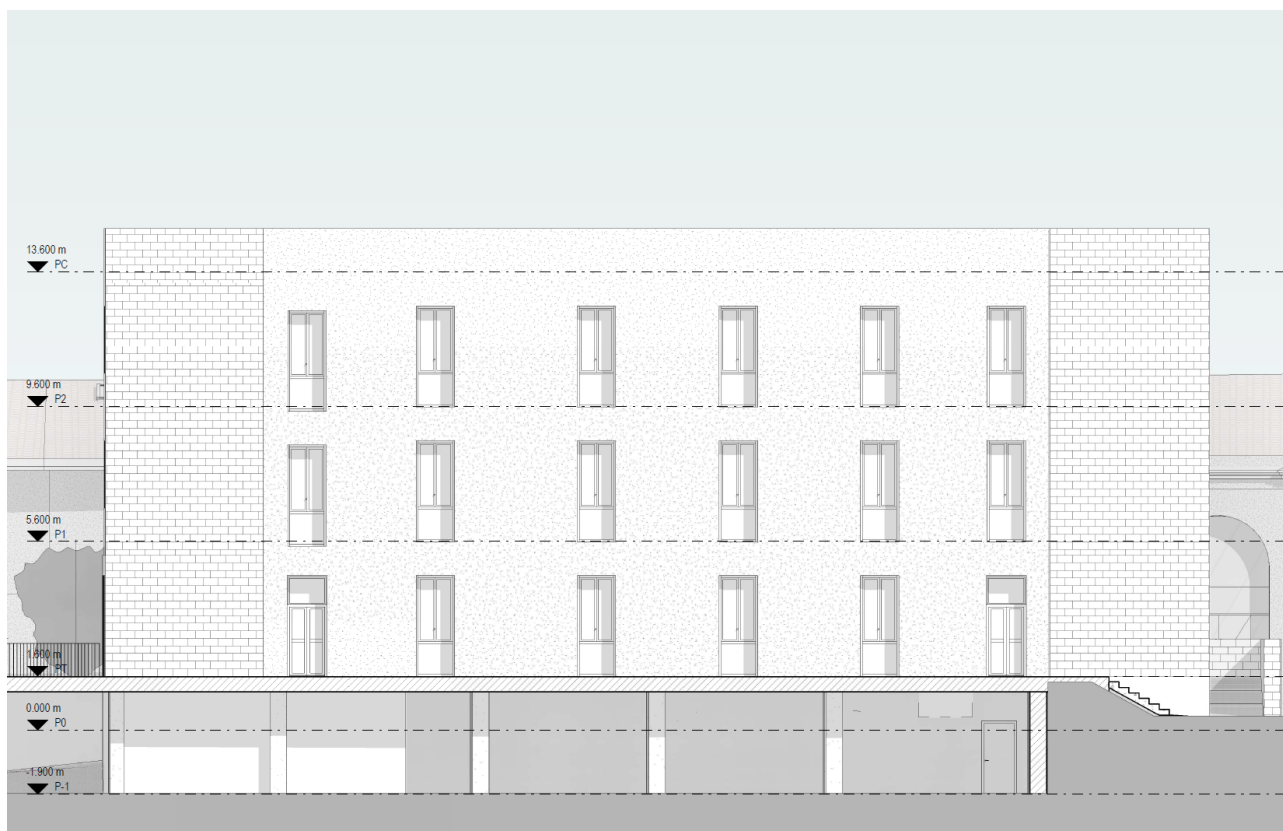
prospetto lato Caserma Gori (prospetto sud-est)
